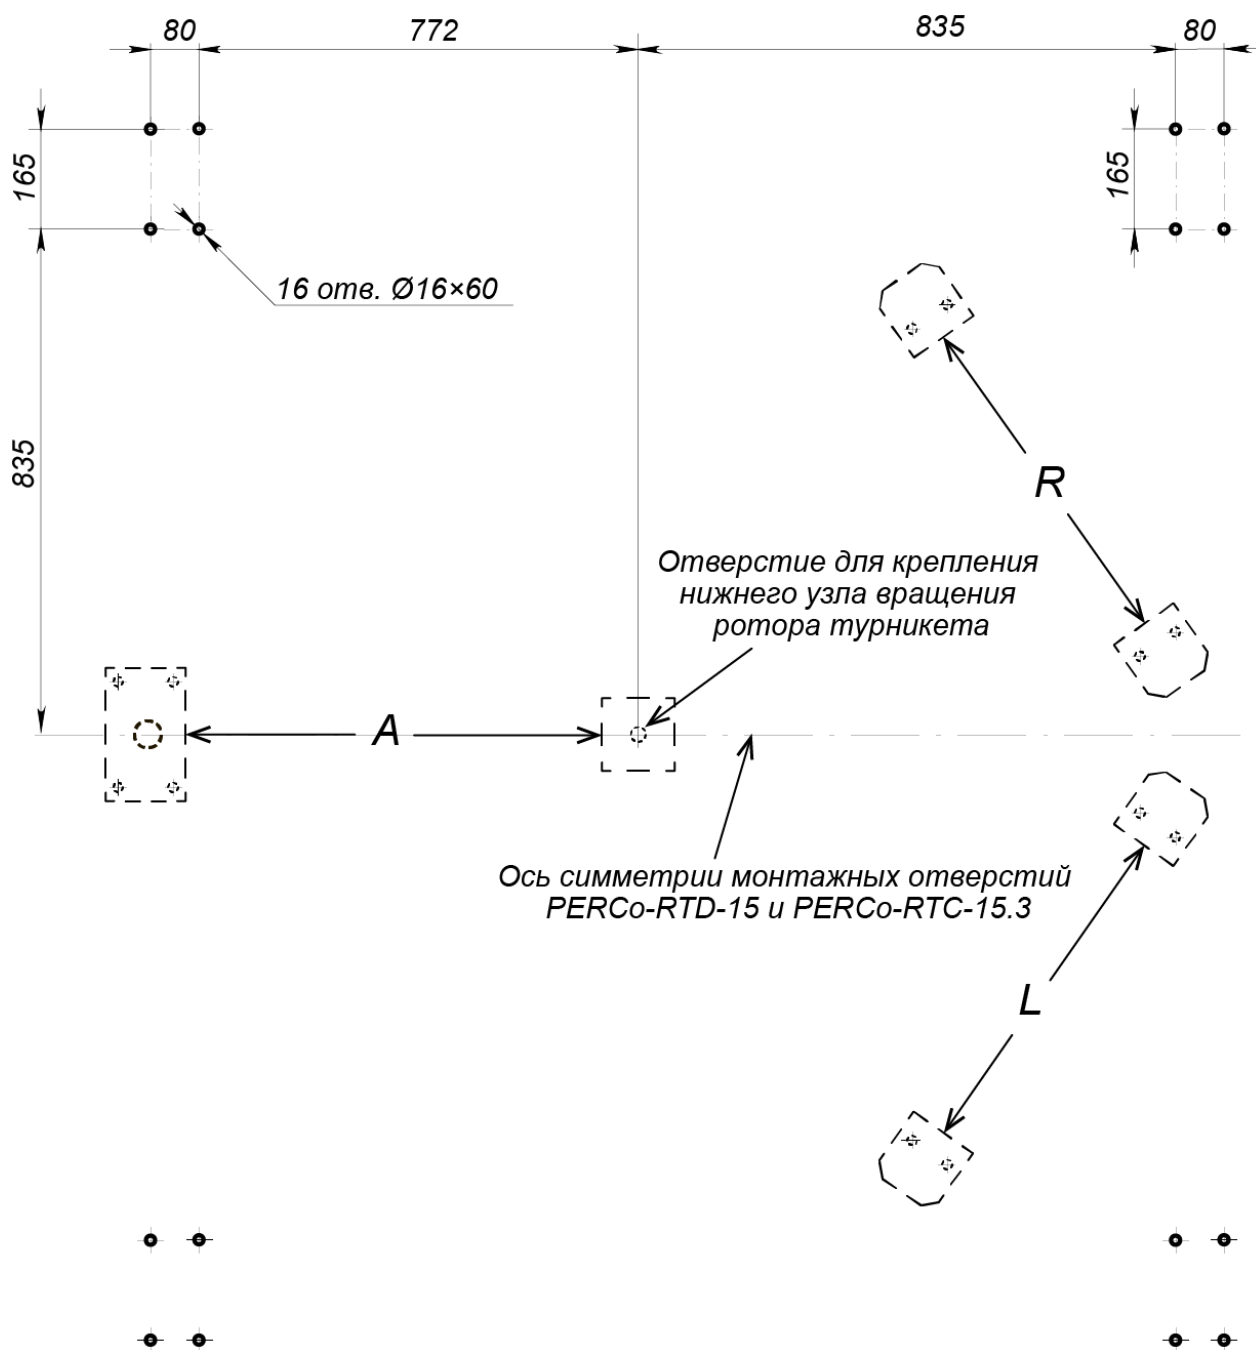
Схема разметки отверстий для крепления стоек (3) крыши относительно отверстий для крепления турникета¹
